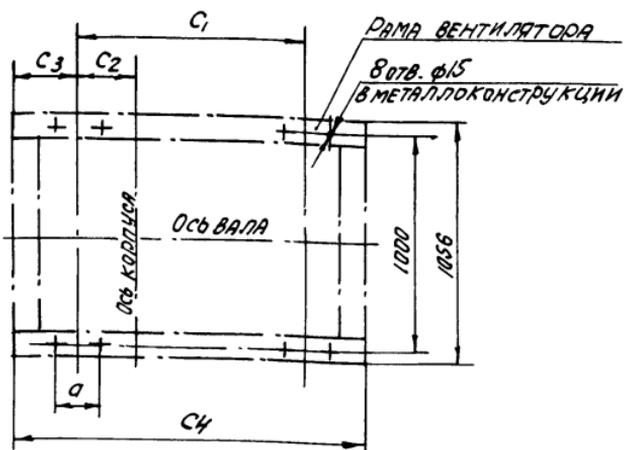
Вентиляторы В-Ц4-708; В-Ц4-70-10 (исполнение 1). План расположения отверстий для крепления вентиляторов с виброизоляторами и без них для всех положений корпуса, кроме на 180° и 118°
